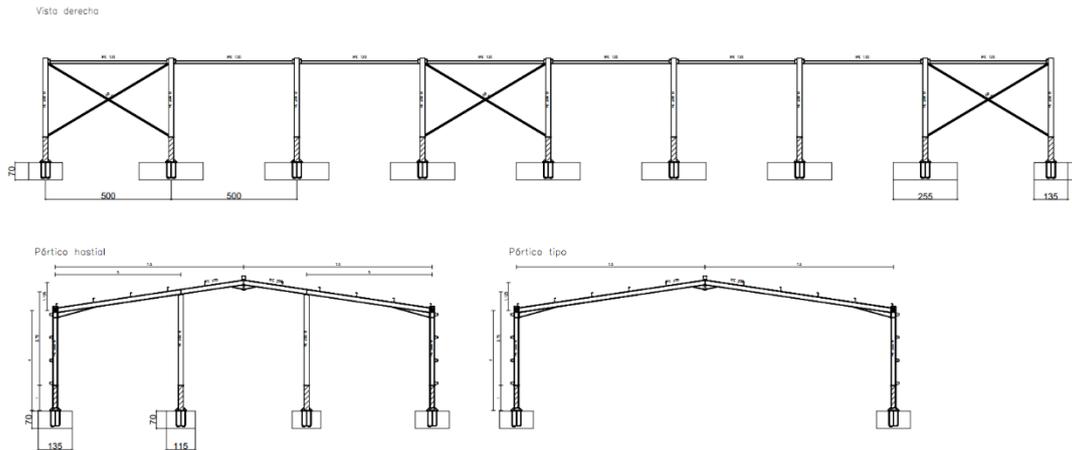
Estructura metálica. Fuente: elaboración propia.
